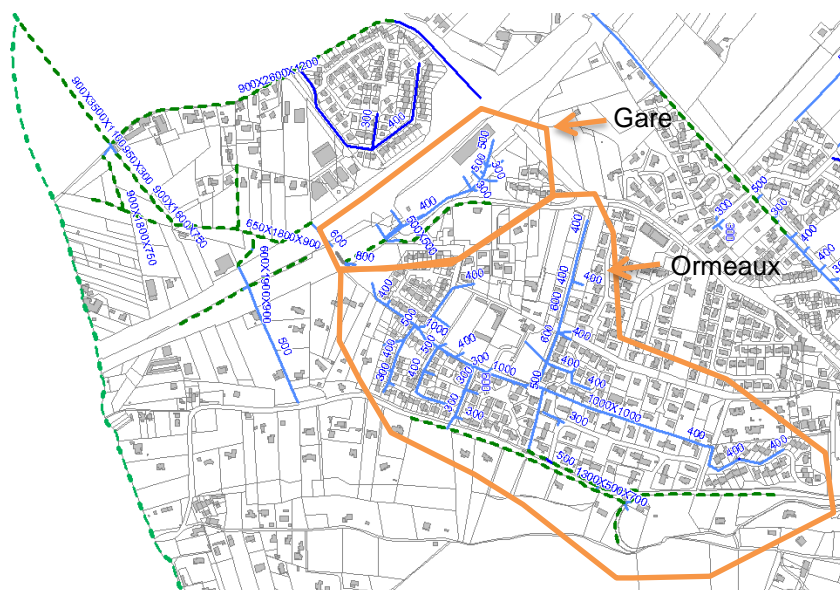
PLAN DU RÉSEAU DE COLLECTE SECTEUR DES ORMEAUX
